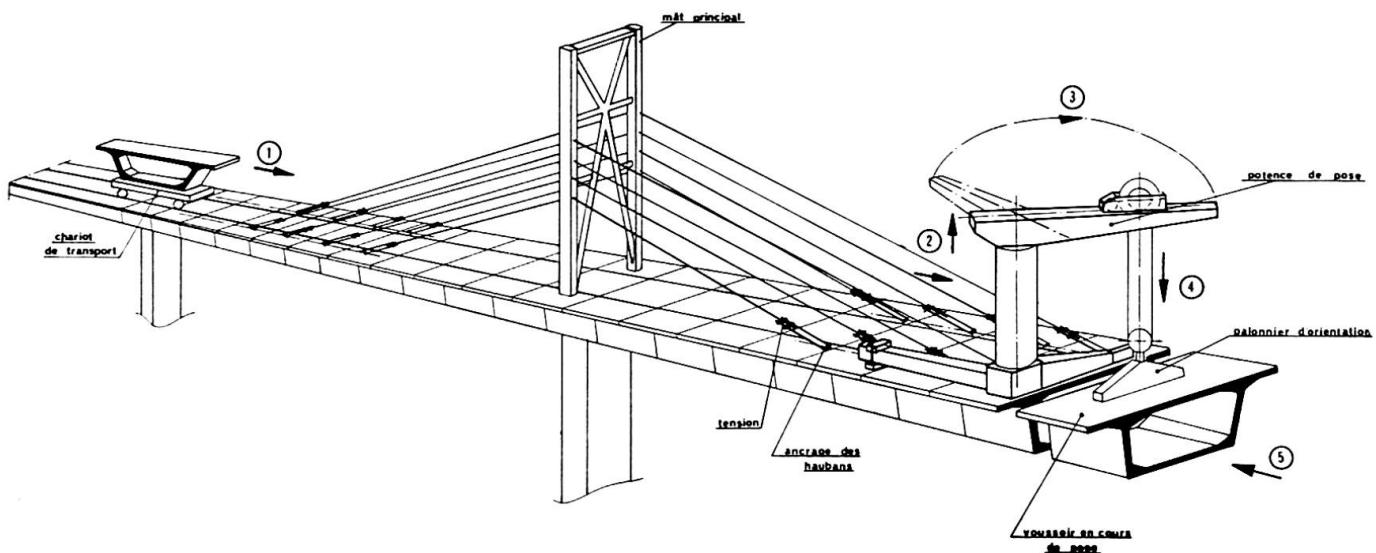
CONSTRUCTION A L'AVANCEMENT
